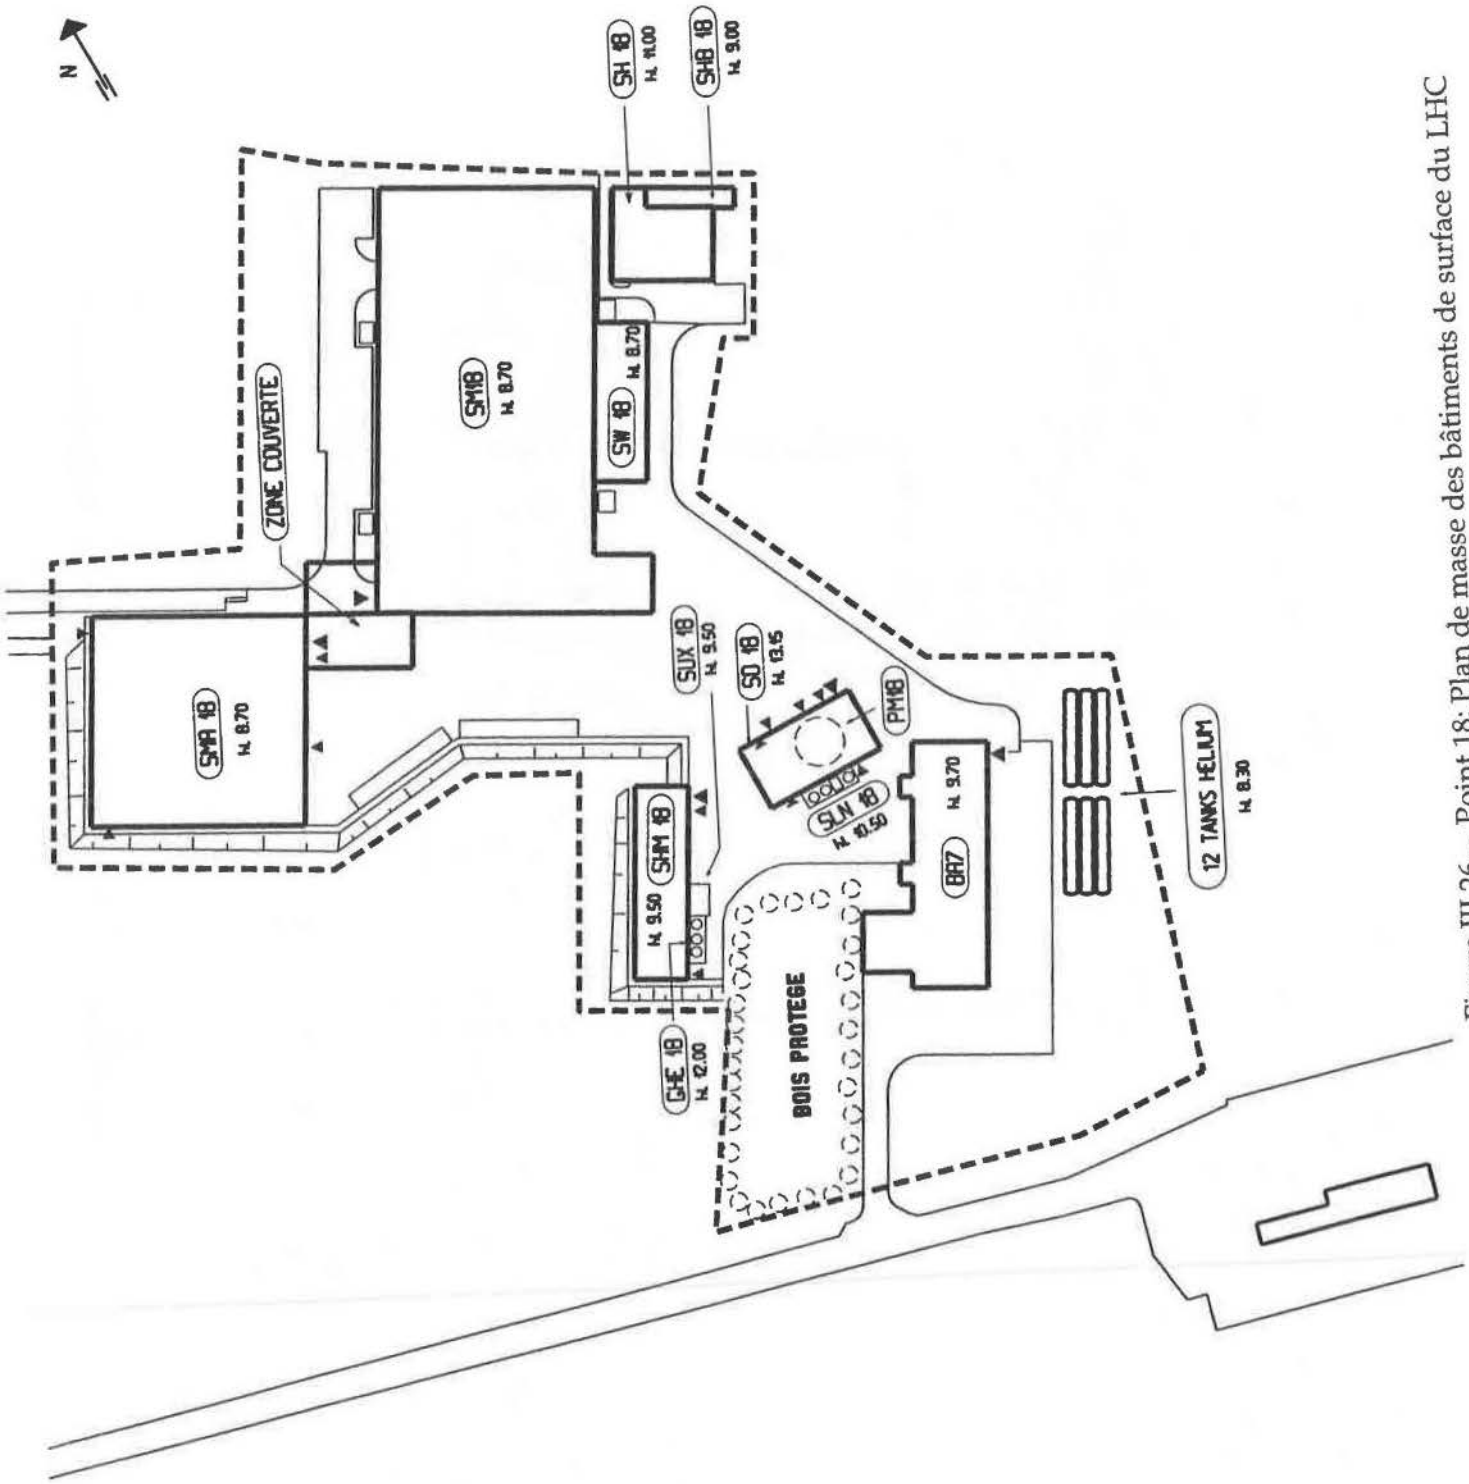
Point 18: Plan de masse des bâtiments de surface du LHC
